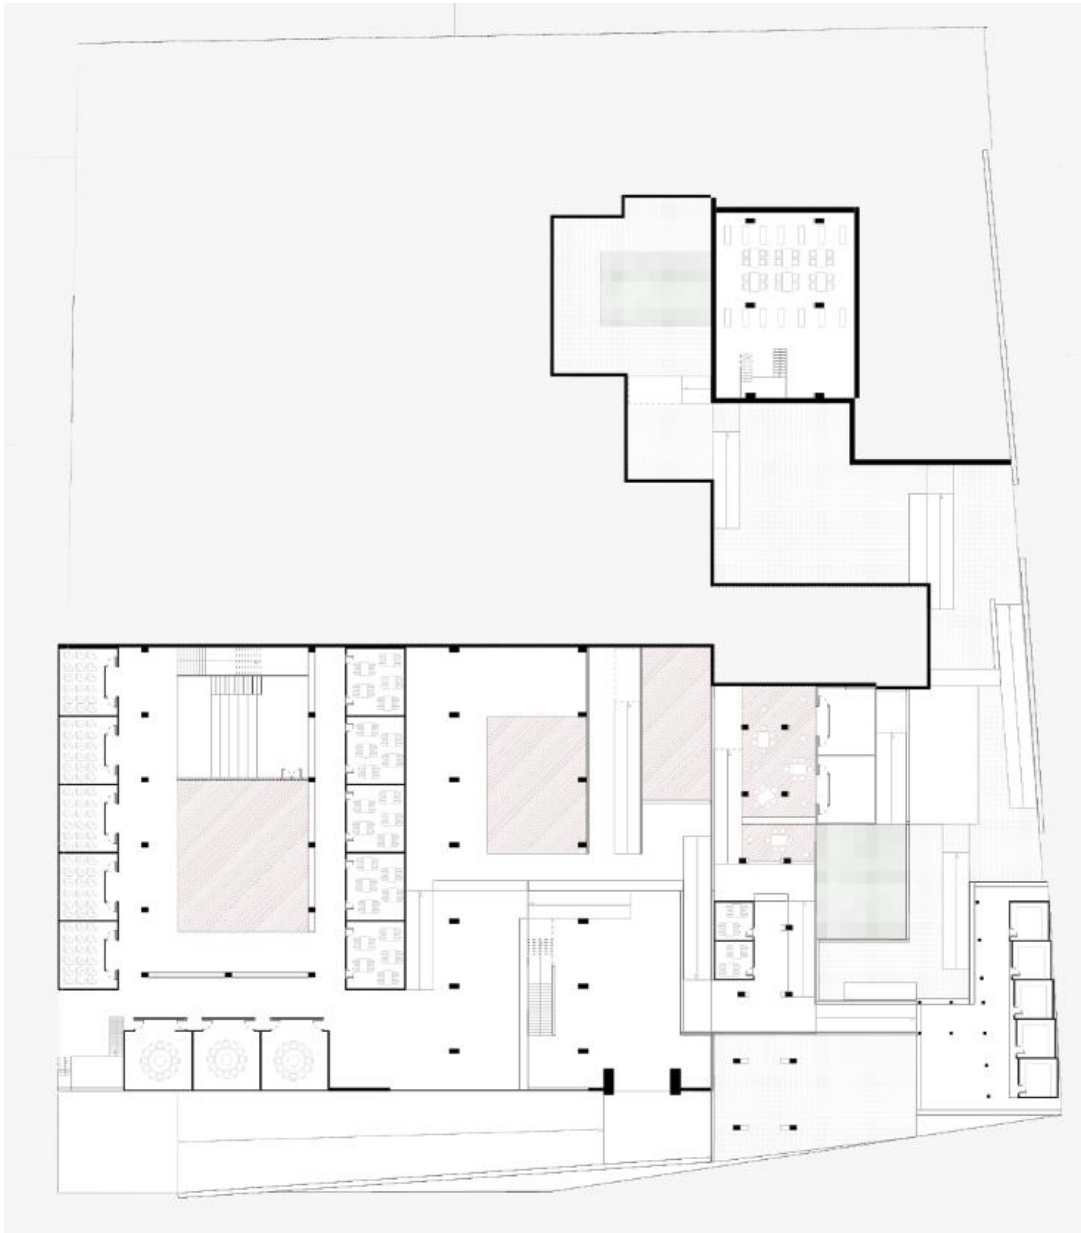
Planta arquitectónica. Primer nivel acceso carrera séptima.
